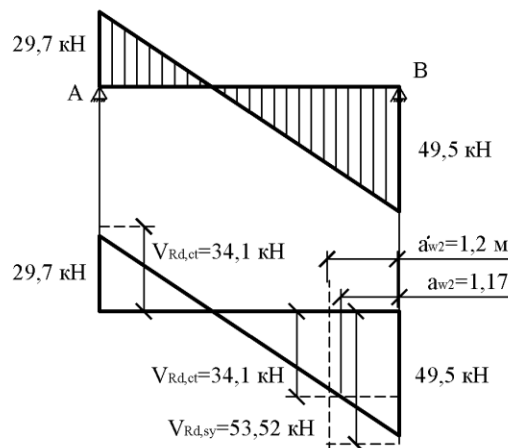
К расчету наклонных сечений по примеру, 5
